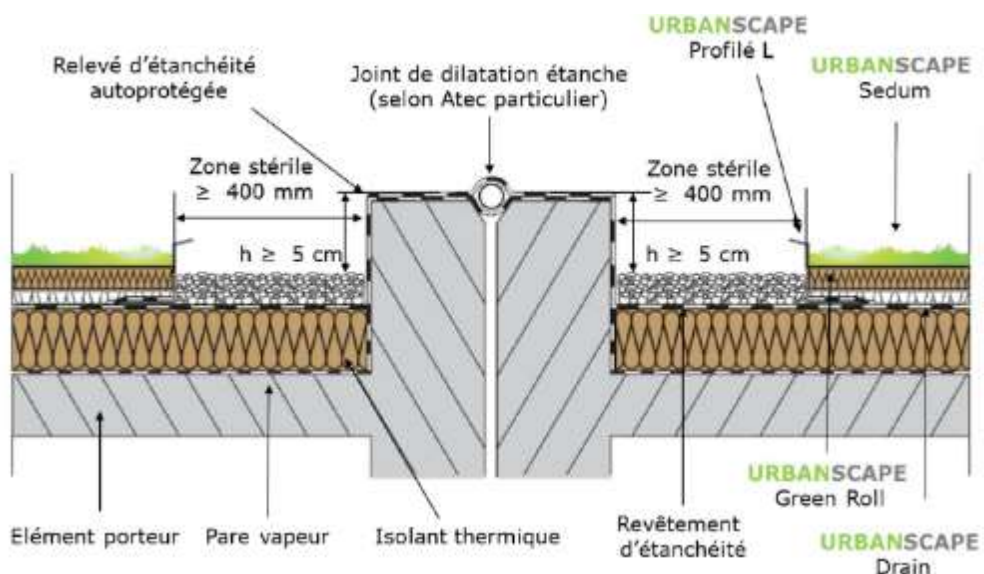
Exemple de joint de dilatation apparent avec ou sans zone stérile sur élément porteur en maçonnerie
